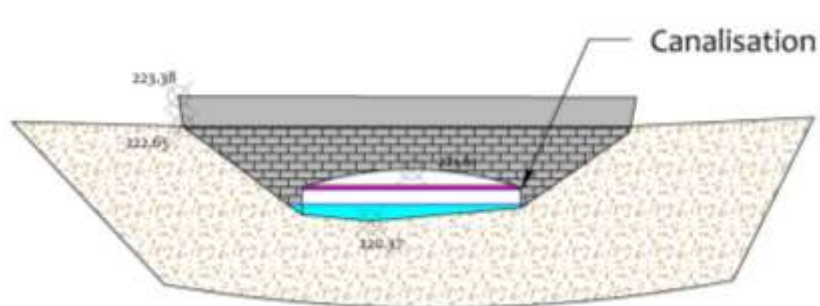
Plan topographique du seuil de stabilisation – Zoom sur le seuil et le pont
